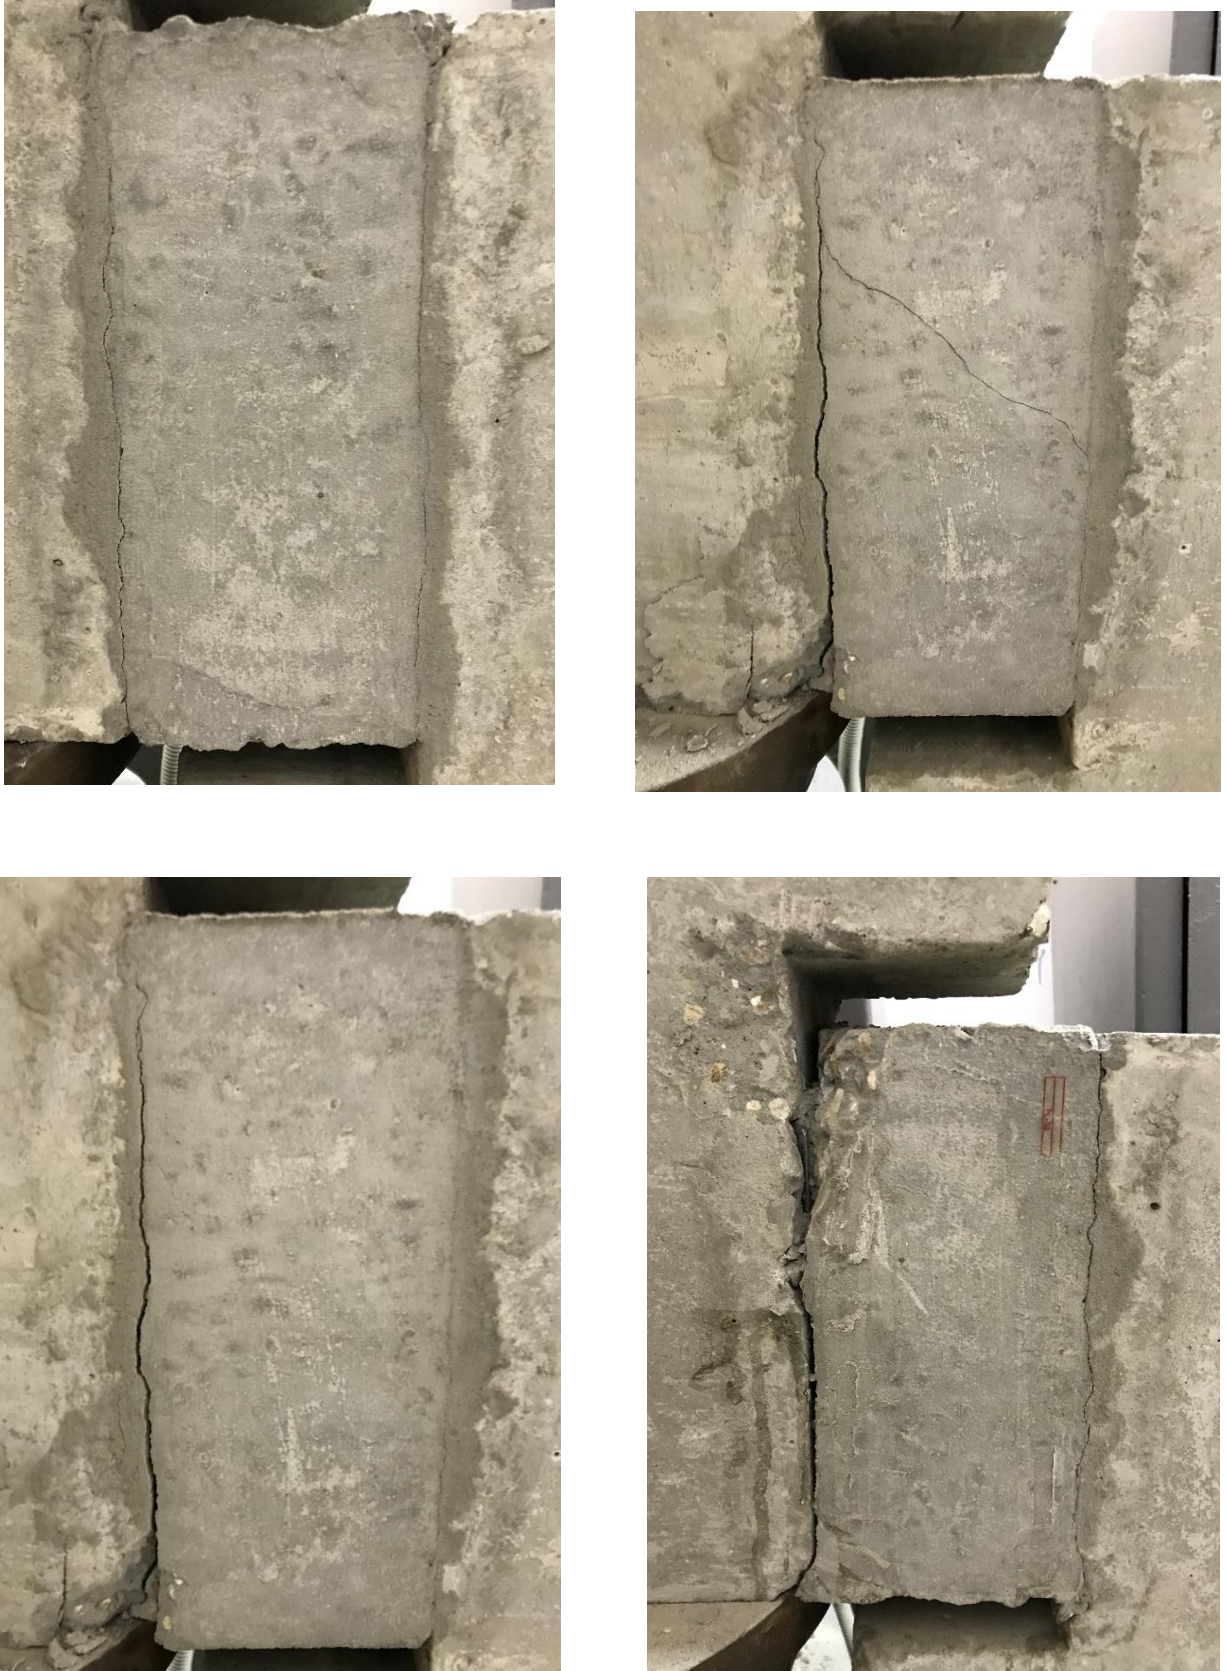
Общий вид разрушения шпоночного соединения.
